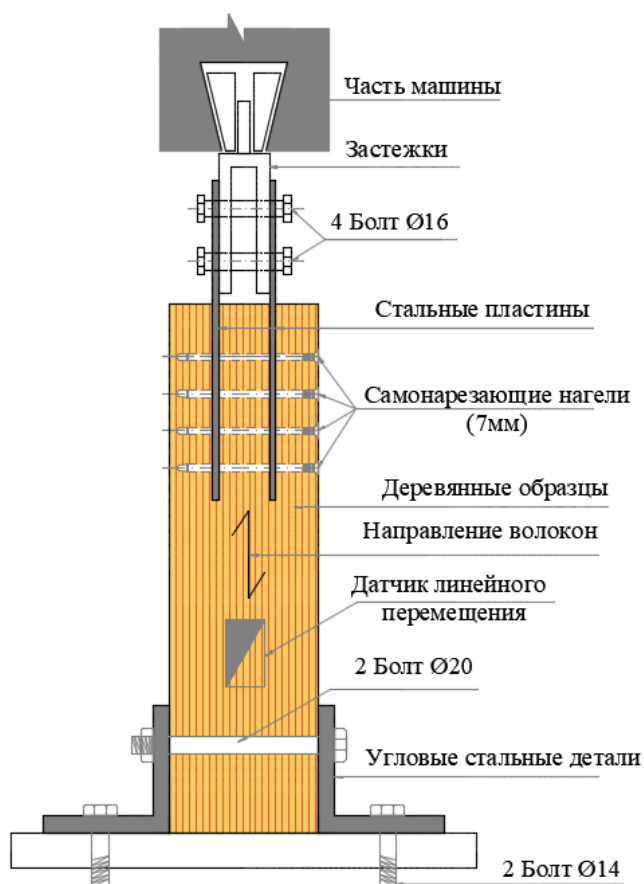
Схема испытания опытного образца соединения «сталь – дерево» с самонарезающими нагелями на растяжение
